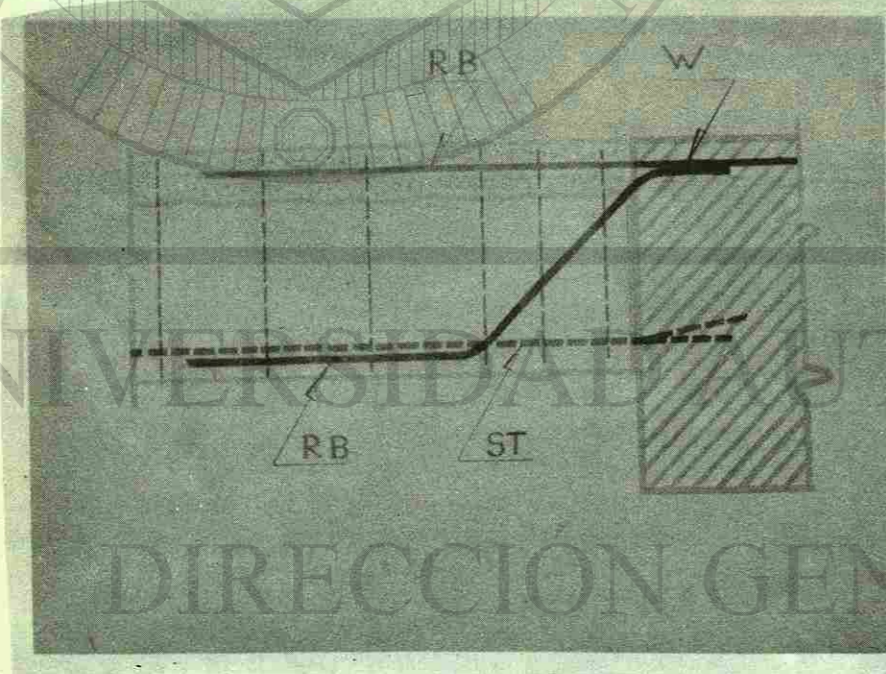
Empotramiento de las viguetas prefabricadas en las vigas postensionadas.
